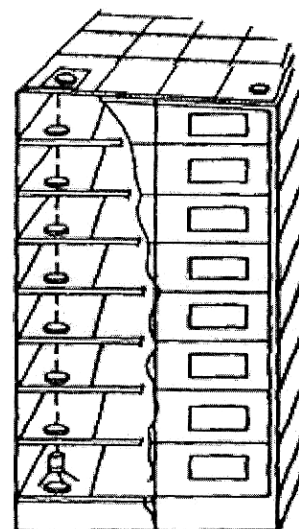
Схема переноса точек опорной сети на монтажный горизонт способом вертикального проектирования
